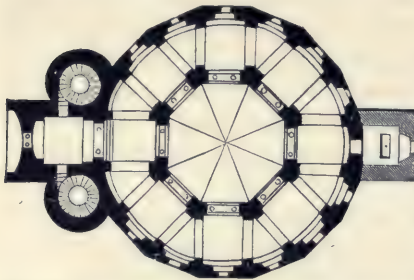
Das Münster zu Aachen in der ursprünglichen Anlage. Grundriss.
